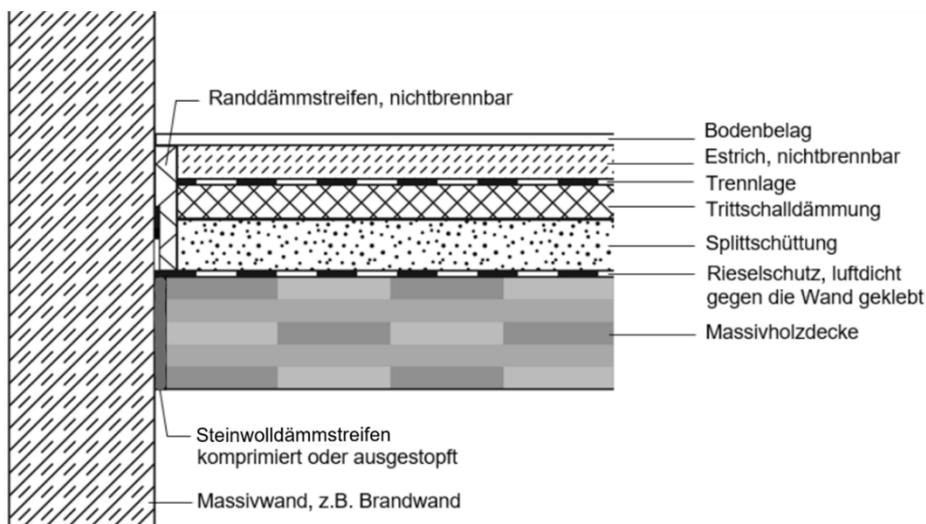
Bauteilanschluss unbelagte Massivholzdecke an Massivwand (Vertikalschnitt) [Muster-Richtlinie 23.05.19]
